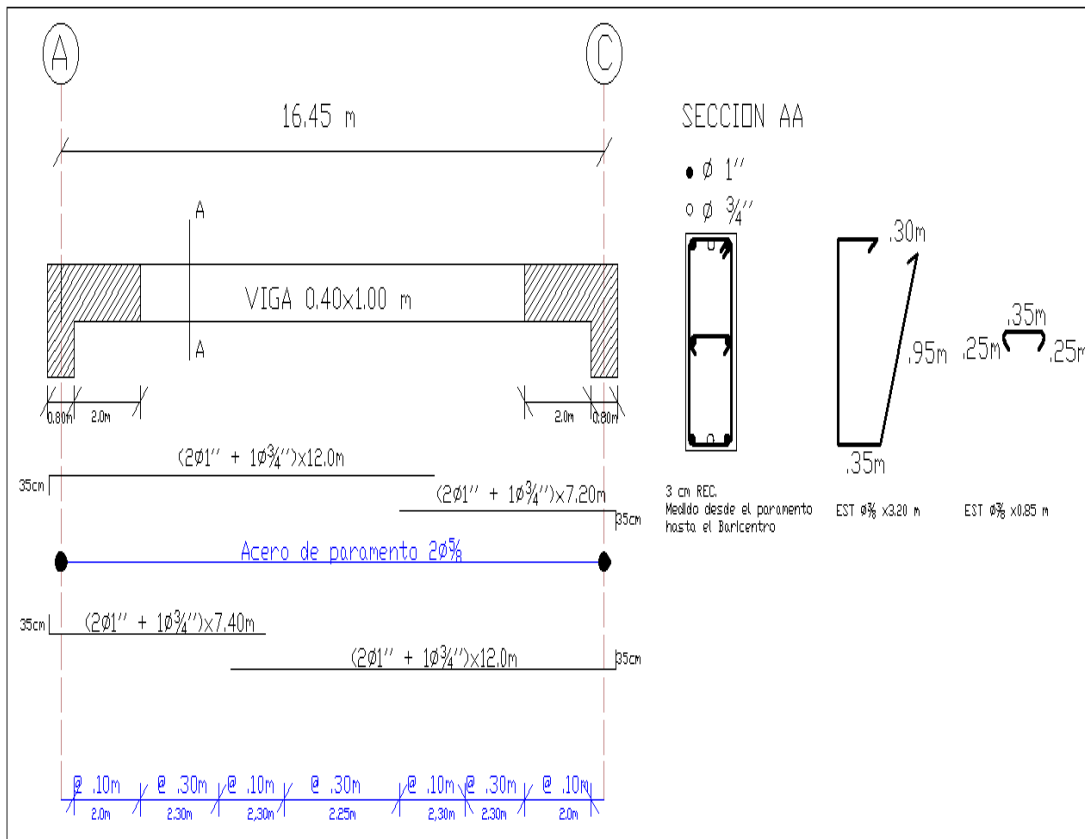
Armado de vigas 1, 5, 10 y 14 (ver planos de detalles).
